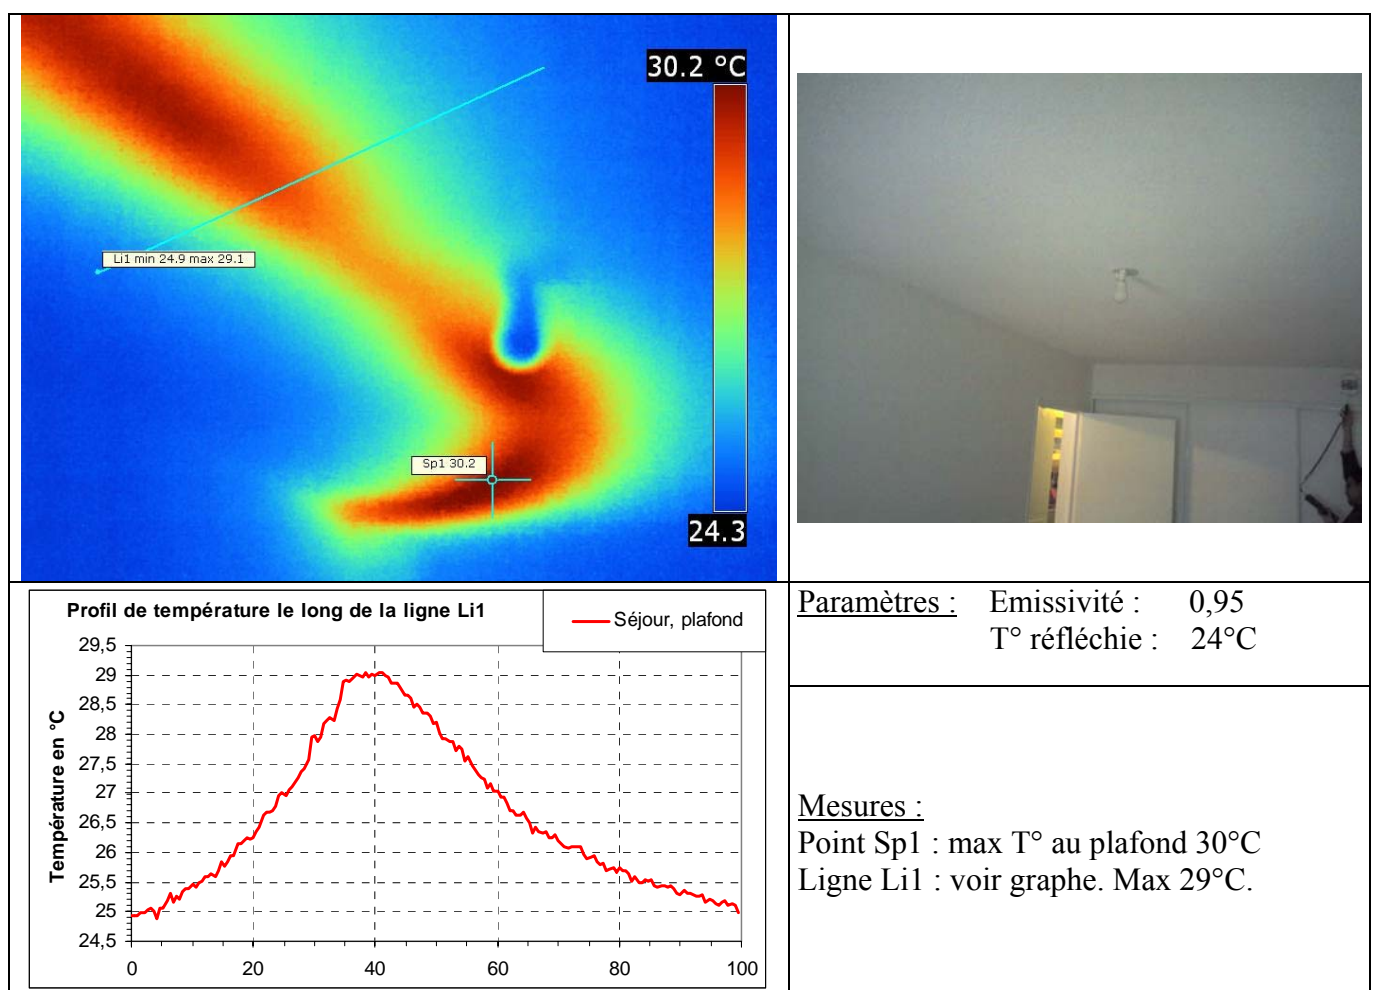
Dauphilogis - Photographie IR du plancher haut du même logement en surchauffe
